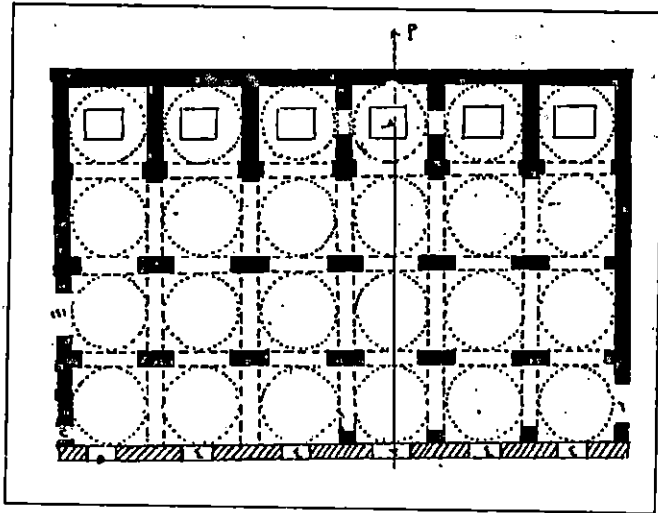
مسقط أفقي لكنيسة ماري جرجس
